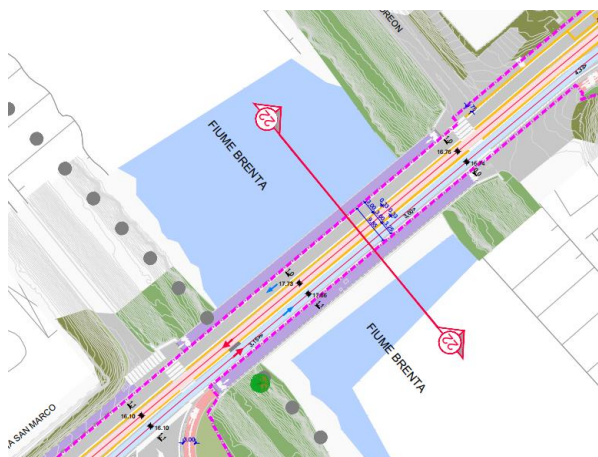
Planimetria generale passaggio rete tramviaria SIR2
